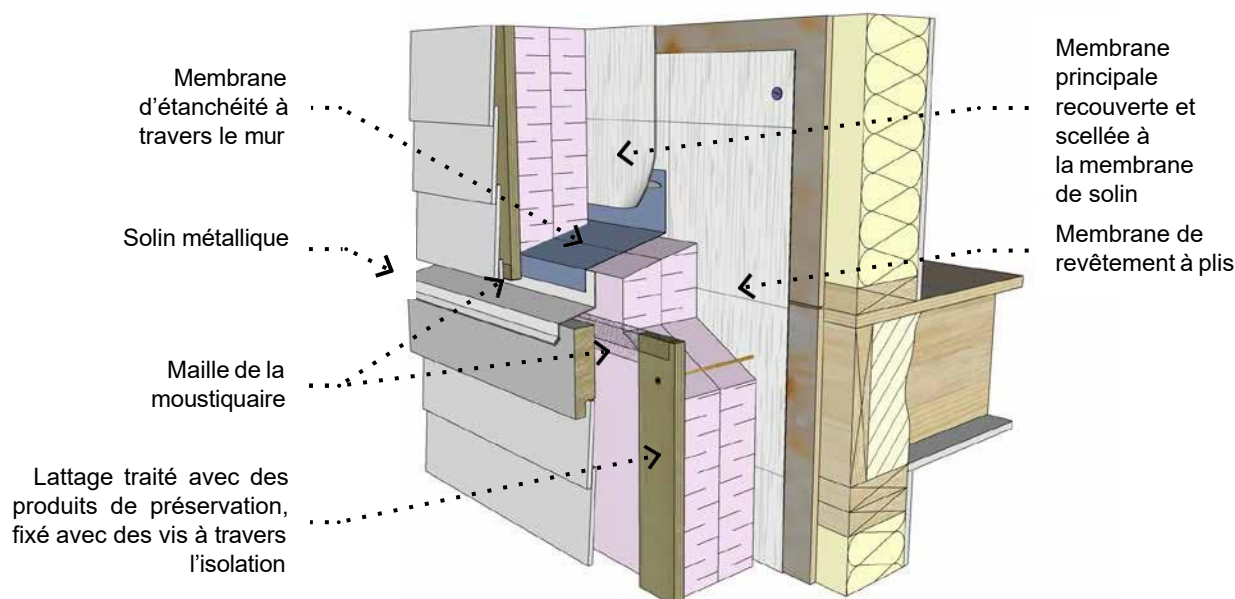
Détail du solin de traversée de mur conventionnel et installation du lattage
